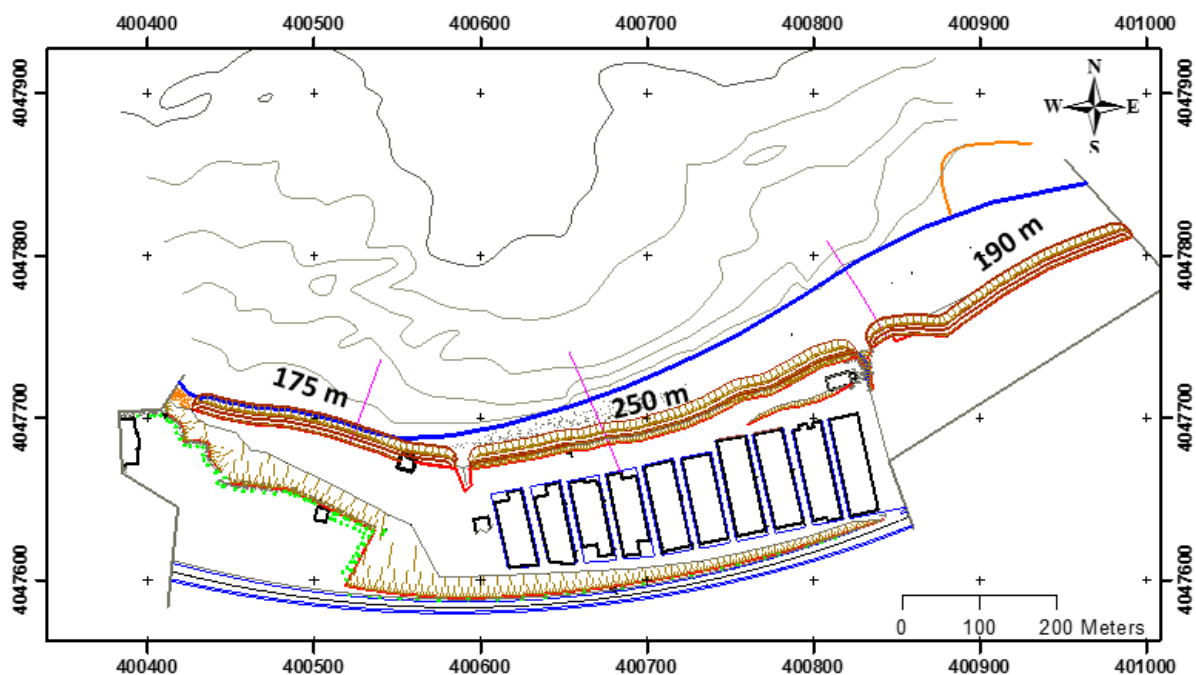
Dimensionnement des ouvrages de protection de haut de plage « plan de masse» (LEM, 2009).
